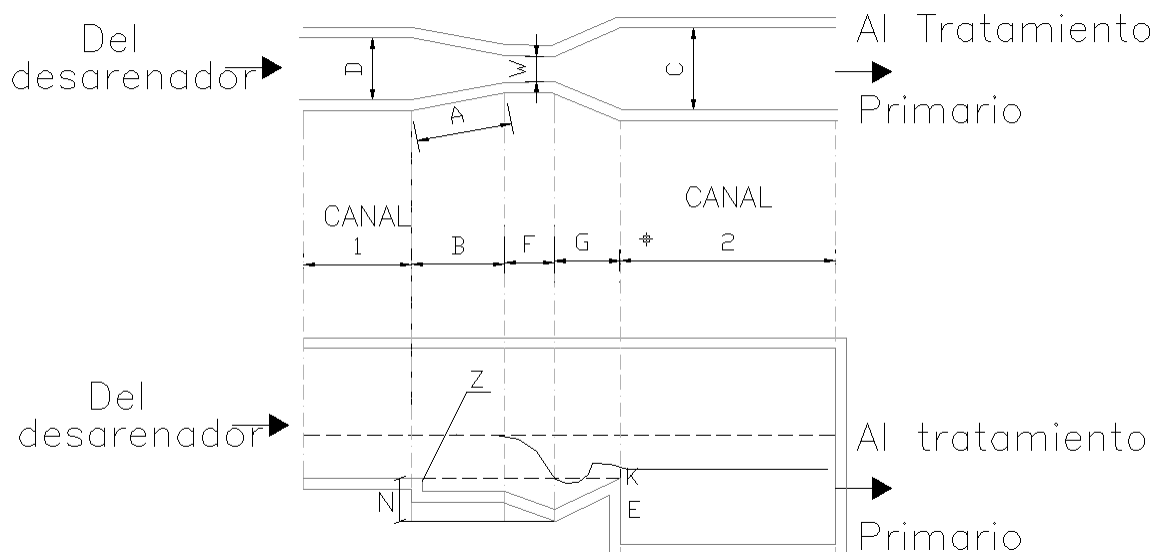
Detalles de las cotas y dimensiones del medidor Parshall.
